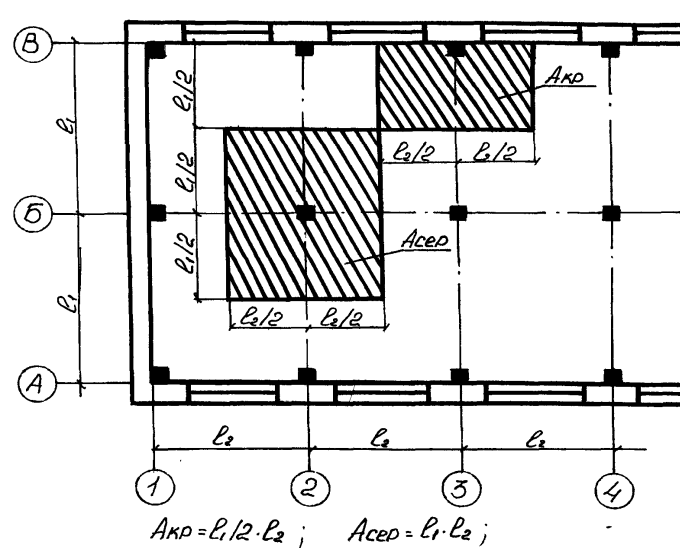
Схематичний план будівлі та вантажні площі для розрахункових фундаментів
